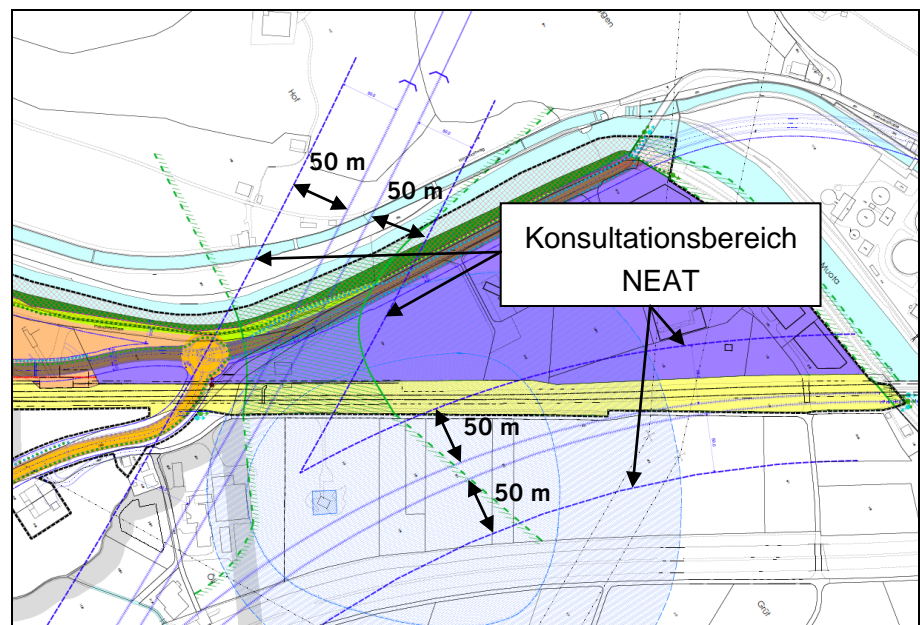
Planausschnitt Neatkorridor (Quelle: Remund+Kuster, 2016)
